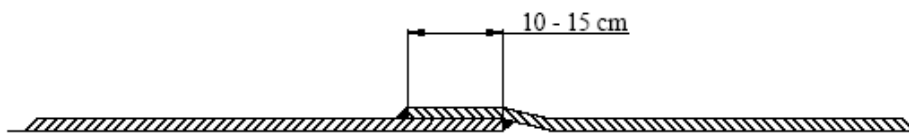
Soldadura tipo T a la unión de tres capas
